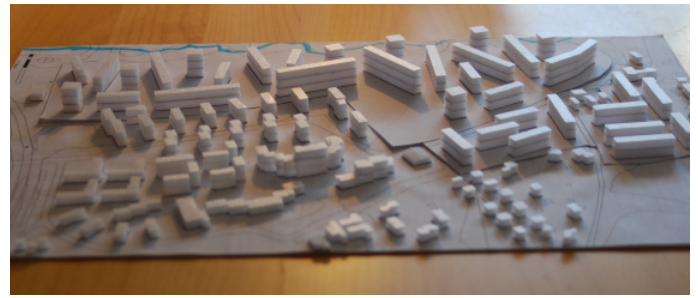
Variante 4: Skizze Lageplan und Modellfotos
